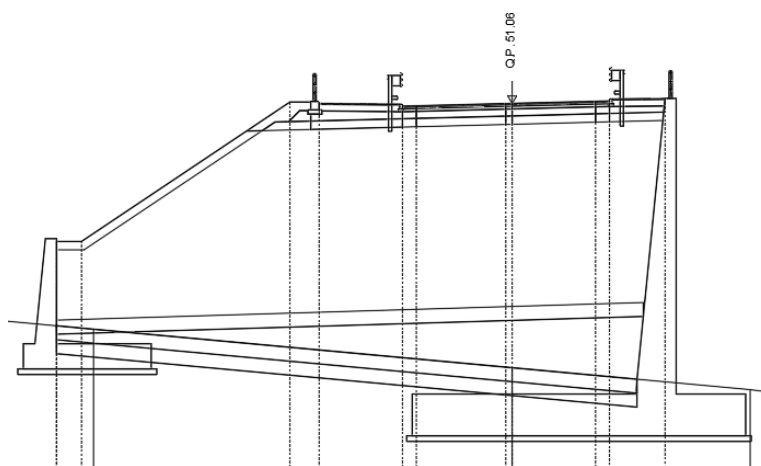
Sezione A del rilevato di appoggio alla spalla A, tra pk 0+253.541 e pk 0+200.000
